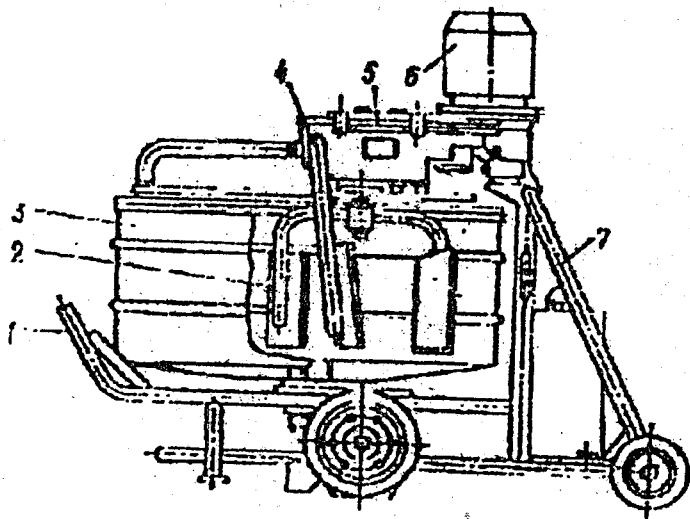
Розчинозмішувач СО-23Б:
